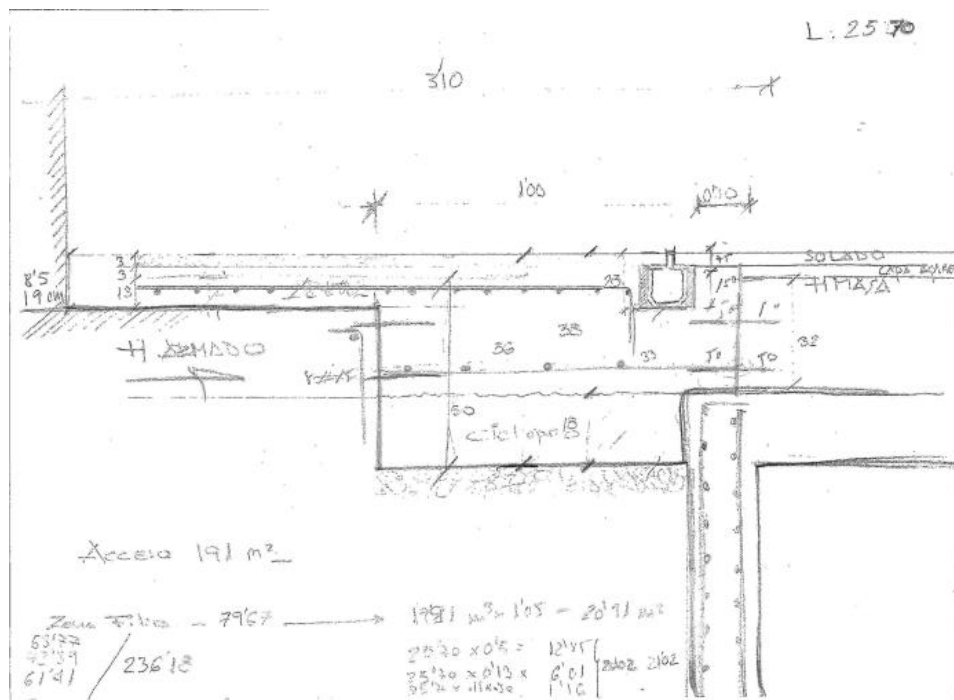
Detalle a mano alzada de la solución constructiva planteada en la Plaza de Acceso. 2017. Fuente: Detalle propio realizado en obra. Martín Arcos, J.
